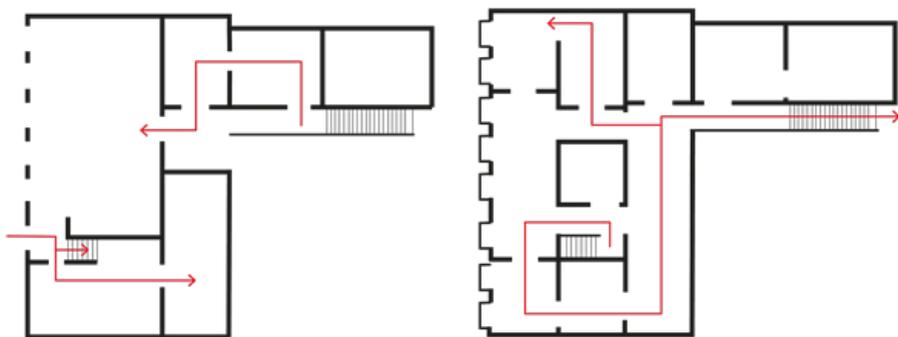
Esquema das plantas do térreo e do primeiro pavimento com a rota da exposição. Fonte: Autor, 2020.
